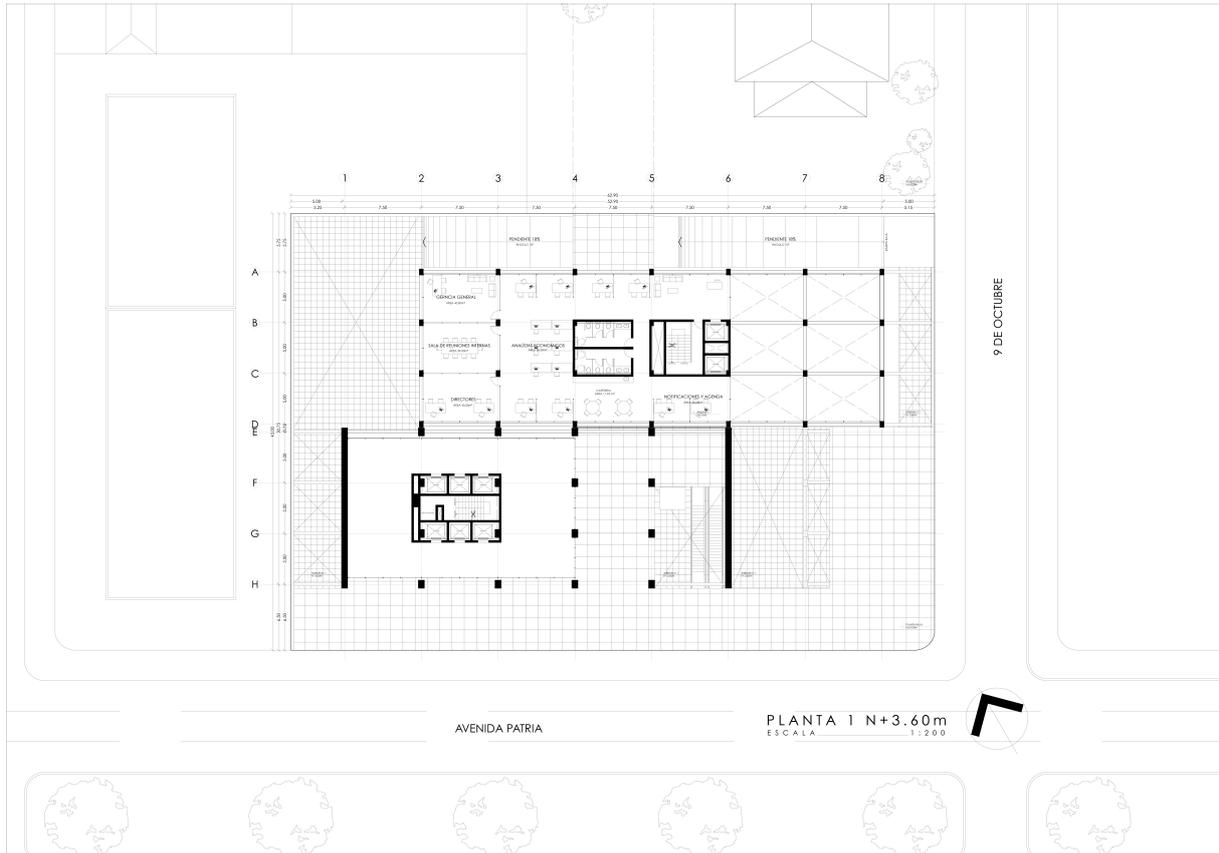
Plantas 1 (N+3.60m). Elaboración Propia
